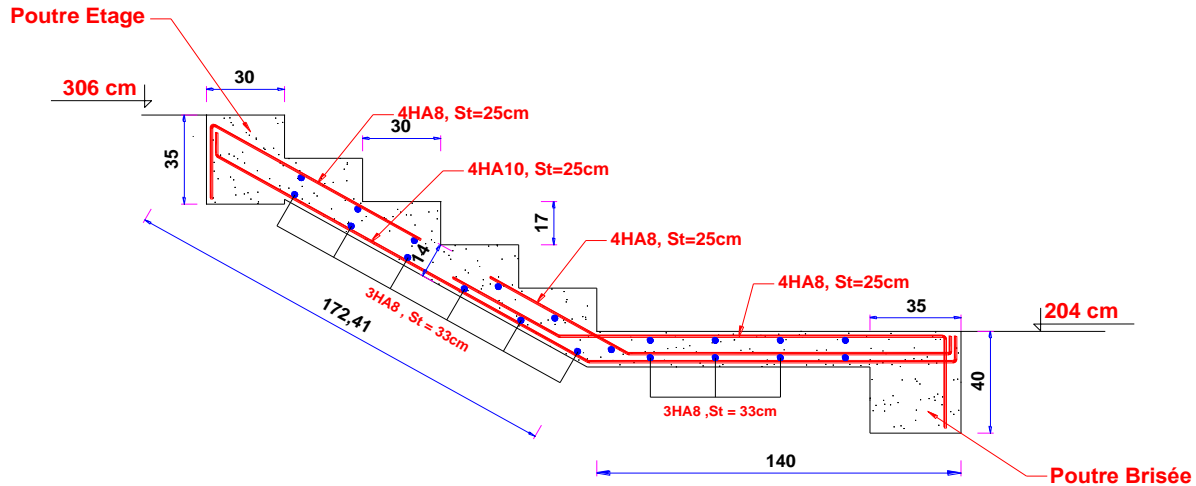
Schéma de ferrailage de l'escalier type (1)
